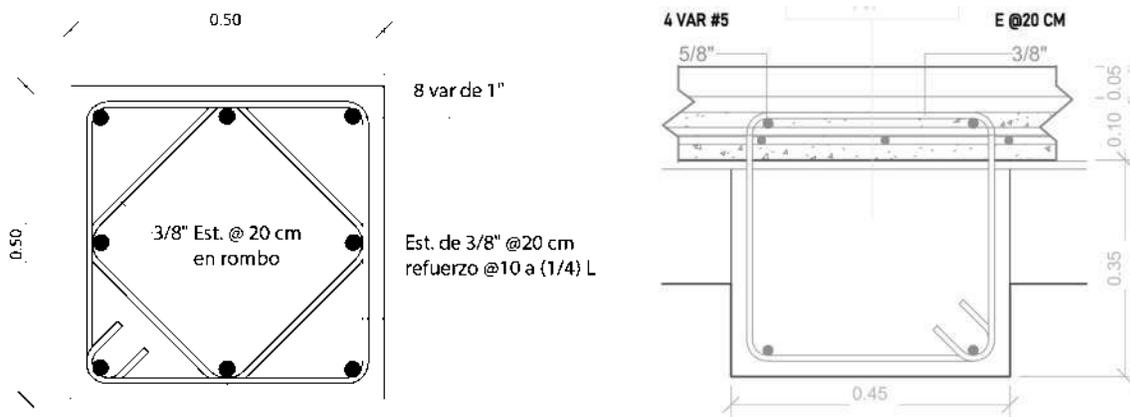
Detalle del armado de las columnas C-1 (izquierda) y de las traveses o nervaduras principales T-1 (derecha). Esquemas de elaboración propia [Zachery R.]
